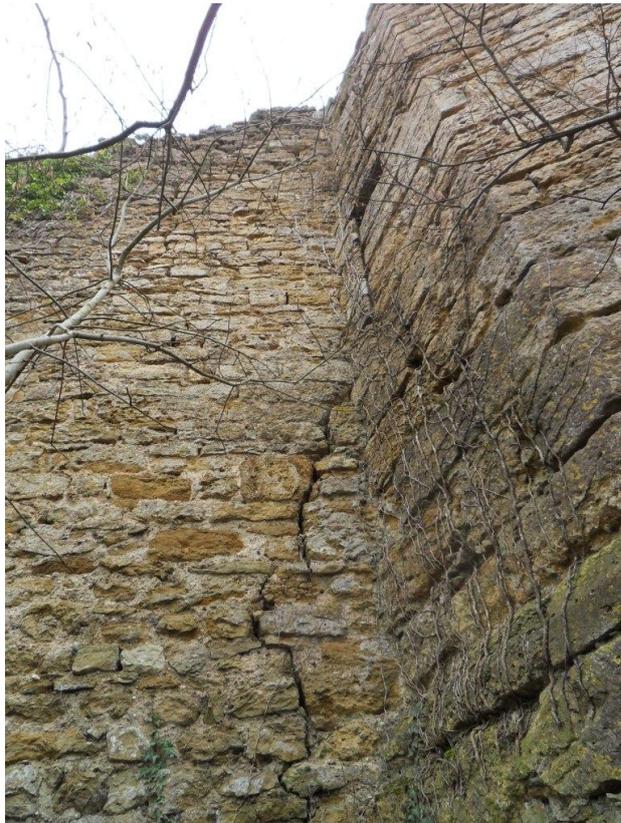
Gros plan sur une des lézardes qui affectent le mur central.
